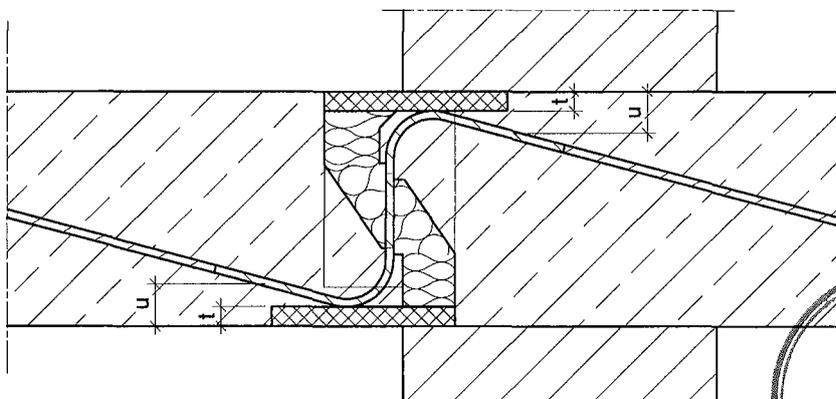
Schöck Isokorb Typ V (F30/F90)
